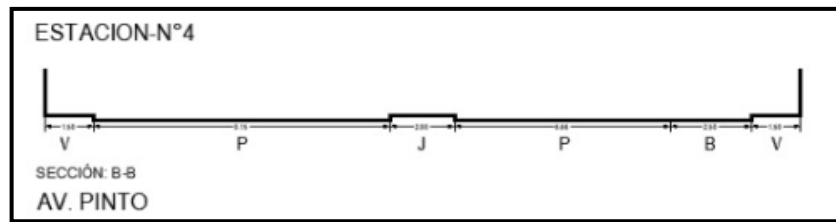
Corte C-C Sección Vial de la Av. Gustavo Pinto
